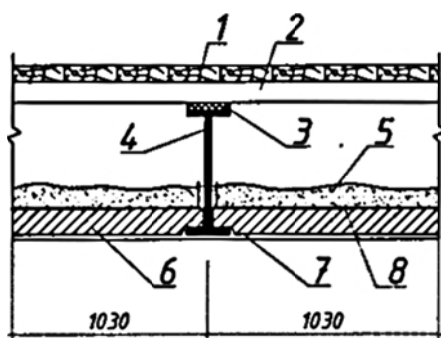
Междуэтажное перекрытие по стальным балкам:
